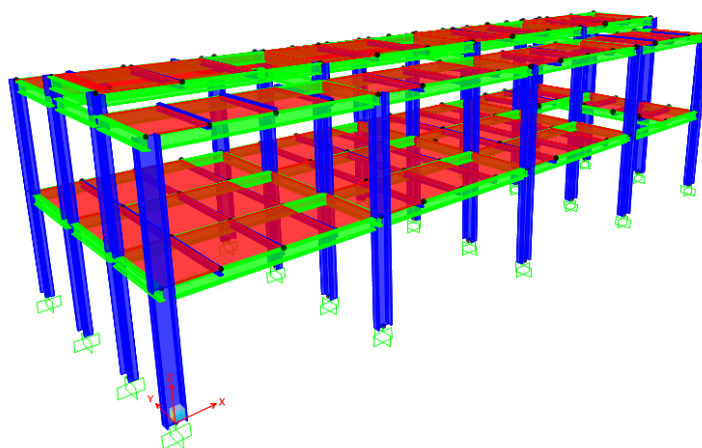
Modelamiento de bloque 3 – acero estructural
